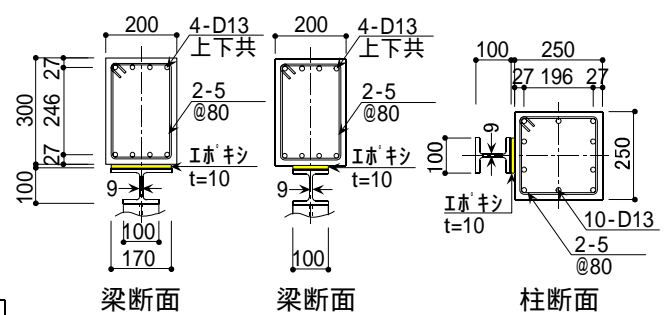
梁断面および柱断面の詳細 (単位 ; mm)
